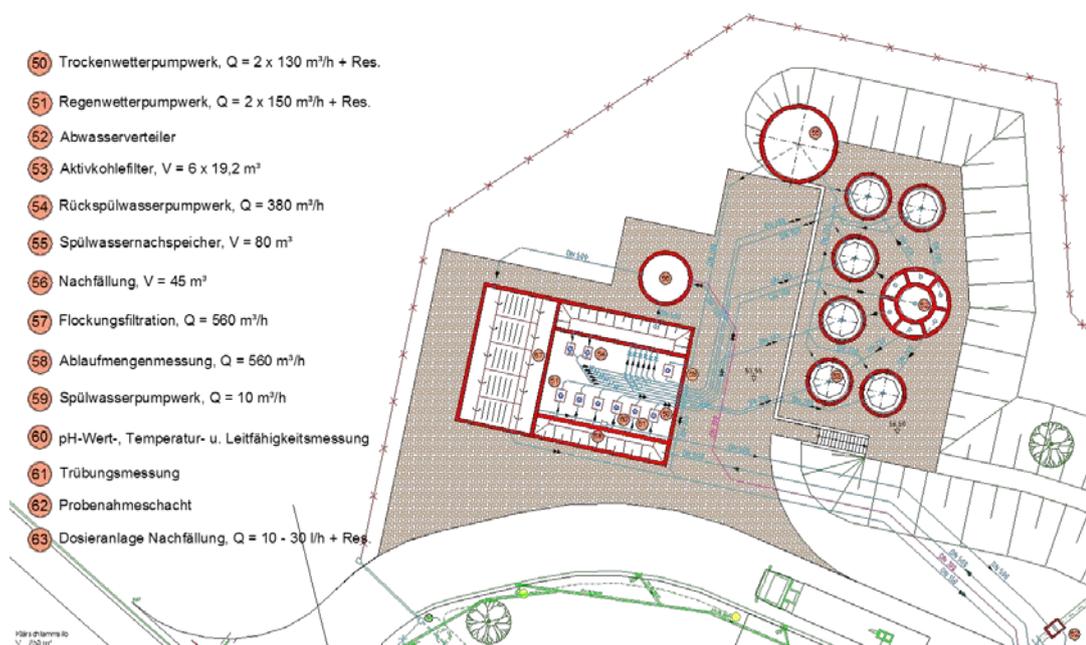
GAK-Filtration, Lageplan, Ausschnitt
